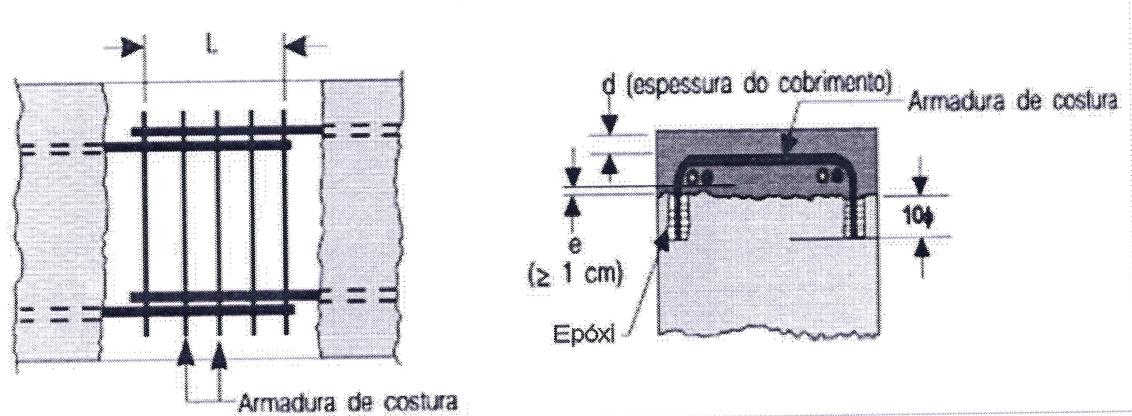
Detalhe da recomposição do aço longitudinal e seu transpasse, furação, ancoragem e recomposição dos estribos e a recomposição da peça estrutural através de gouth..
